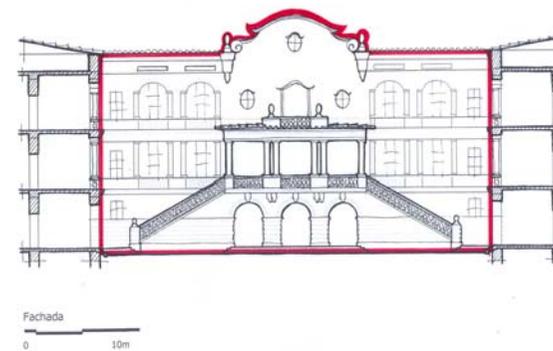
Estudo de proporção do pátio interno do ISERJ, vista da fachada Noroeste (Fonte: O AUTOR,2006).
